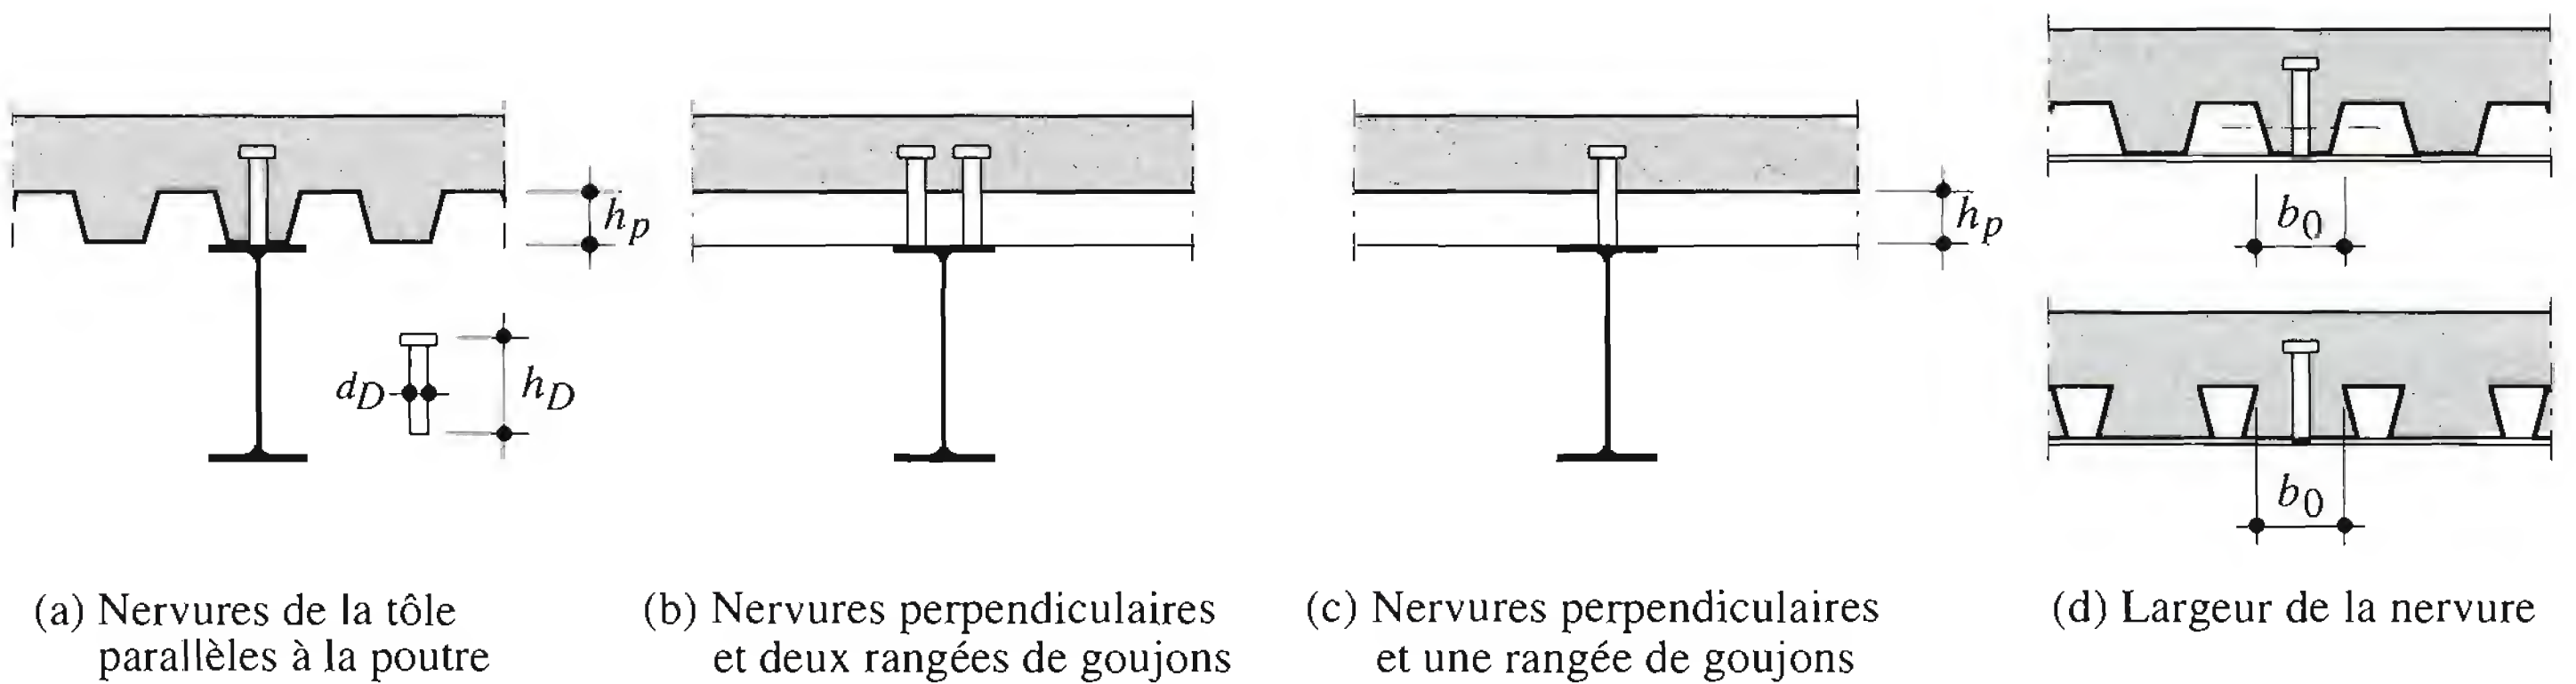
Poutre mixte composée d'un profilé métallique et d'une dalle mixte avec tôle profilée.
